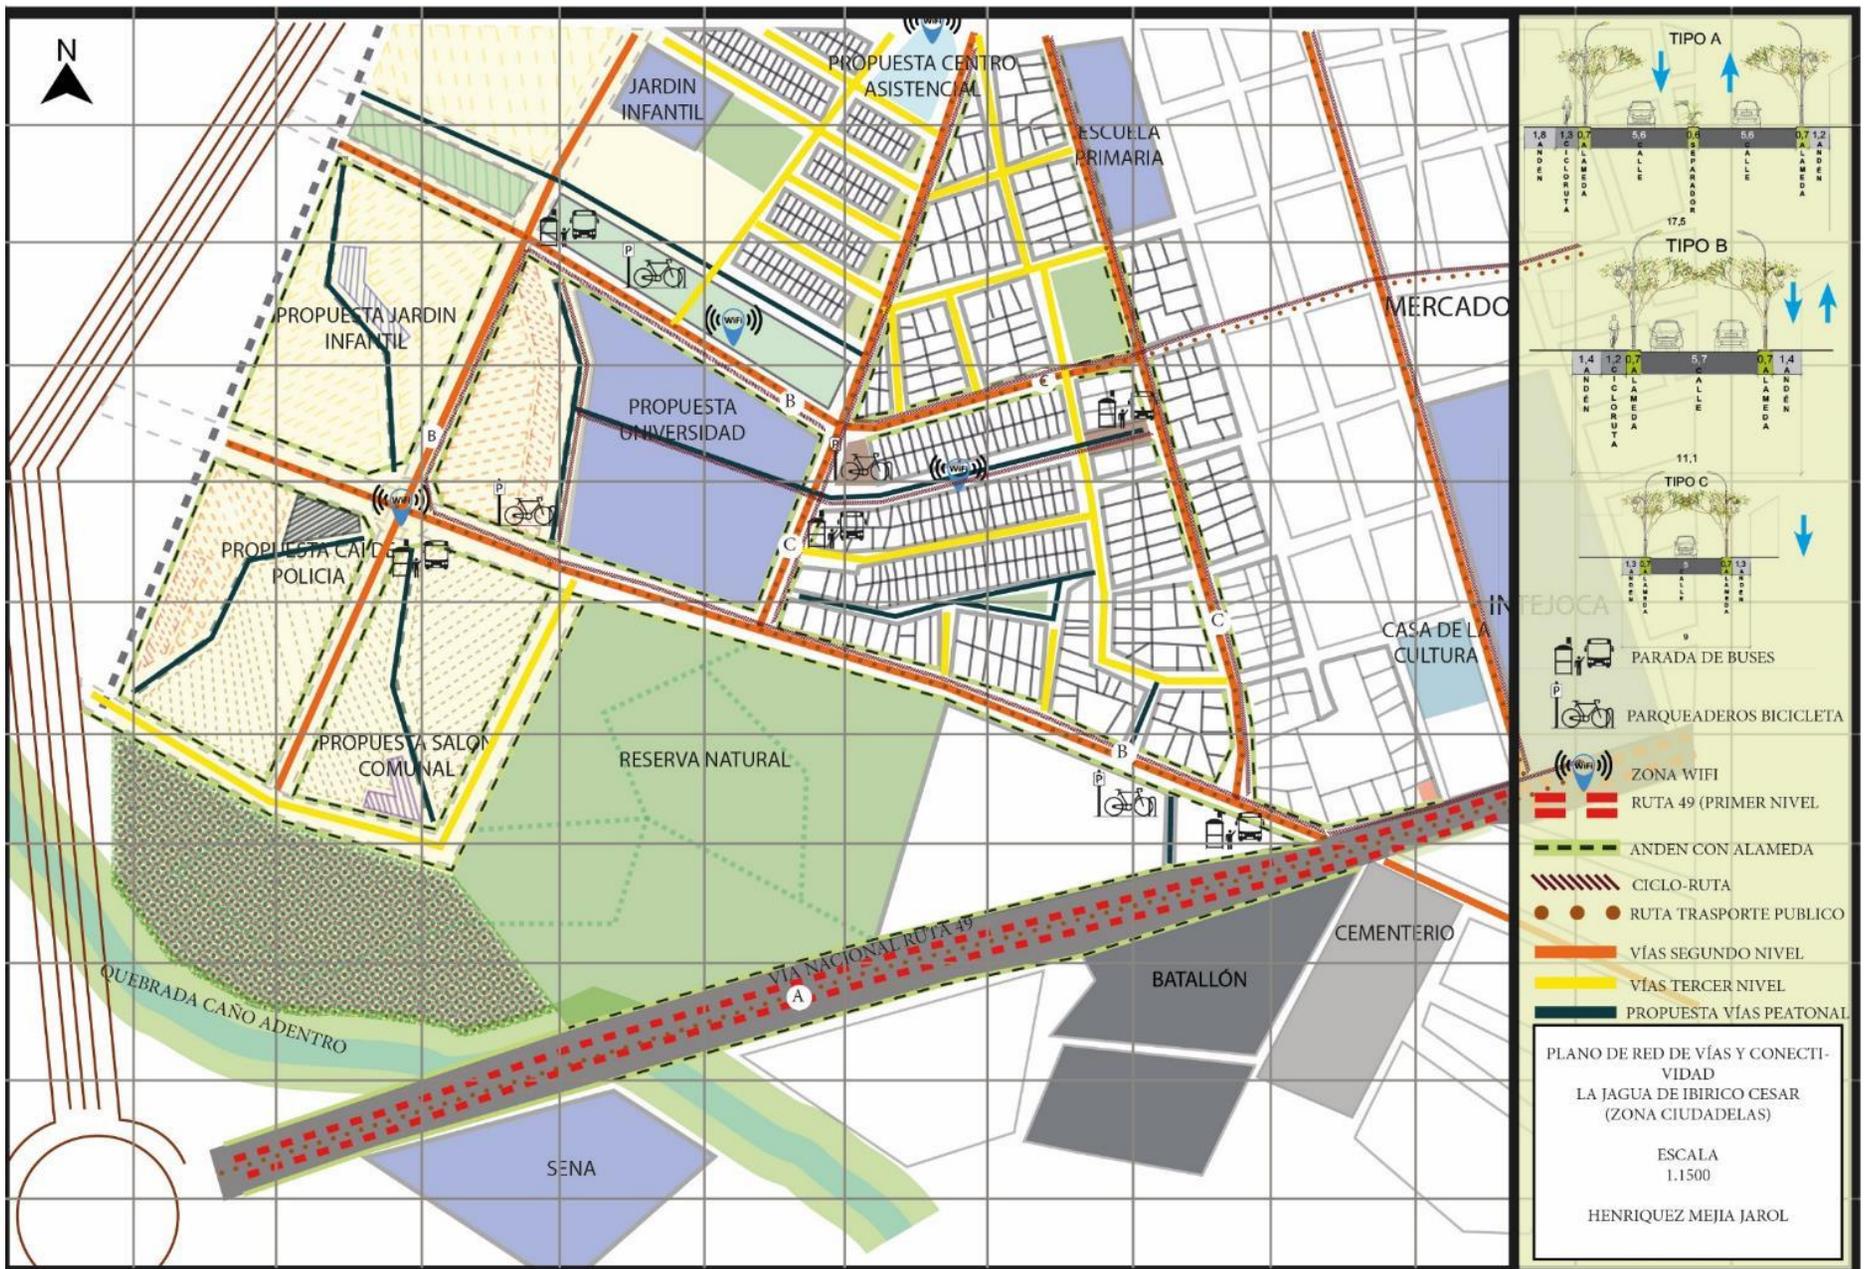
propuesta vial y de conectividad de la zona de expansión y sector de trabajo, fuente: elaboración: propia
